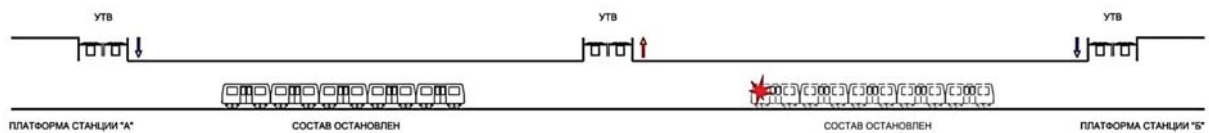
Продольная схема противодымной вентиляции с промежуточной УТВ
